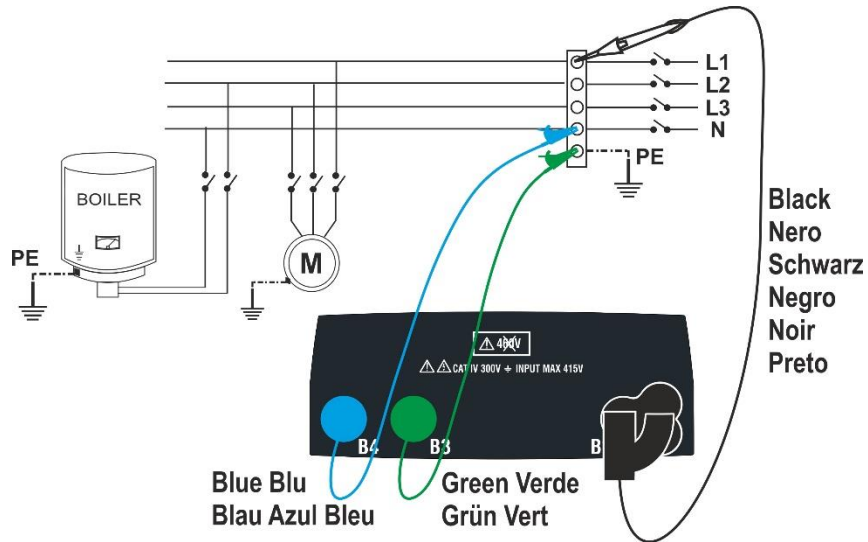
Isolationstest mellan L-N-PE med testledningar och fjärrbetjätningsprob (MAN och AUTO)
